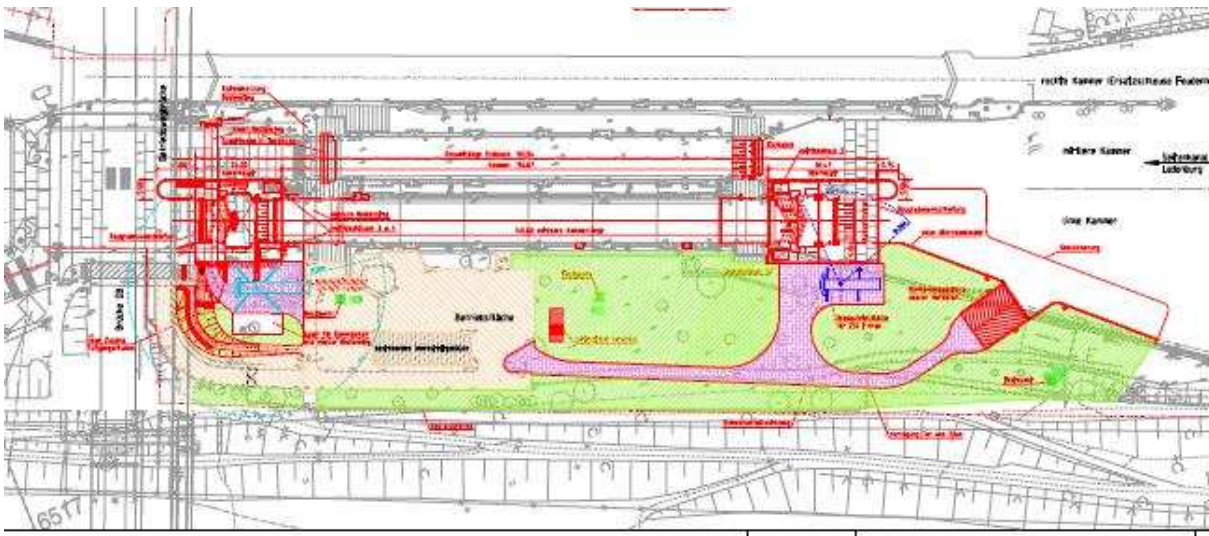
Ausschnitt Grundrissplan aus der Entwurfsplanung
